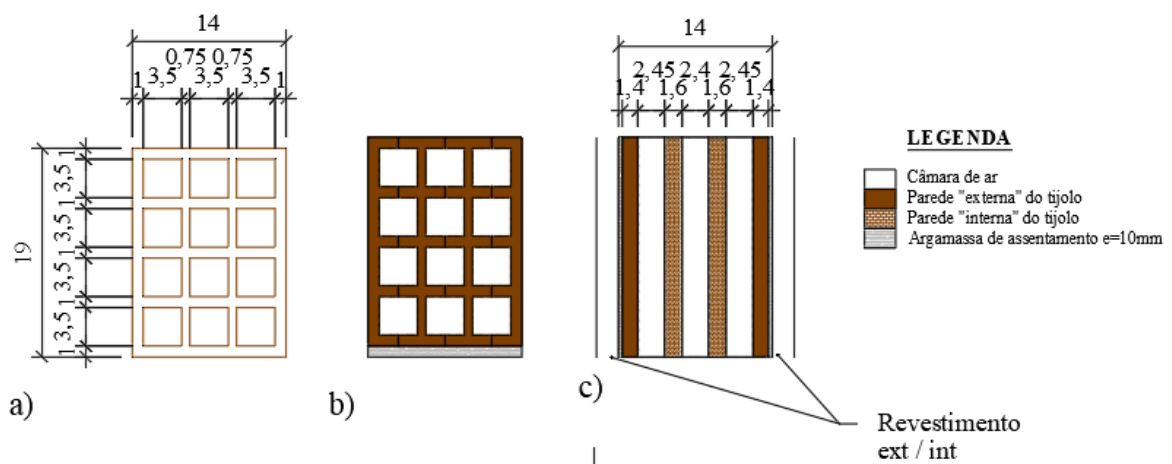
Representação da parede de alvenaria considerando a) As dimensões do bloco cerâmico adotado e dos furos b) O bloco cerâmico com a argamassa de assentamento c) A parede de alvenaria considerando a argamassa de assentamento, as paredes do bloco cerâmico e a câmara de ar com espessura uniforme ao longo do seu comprimento
